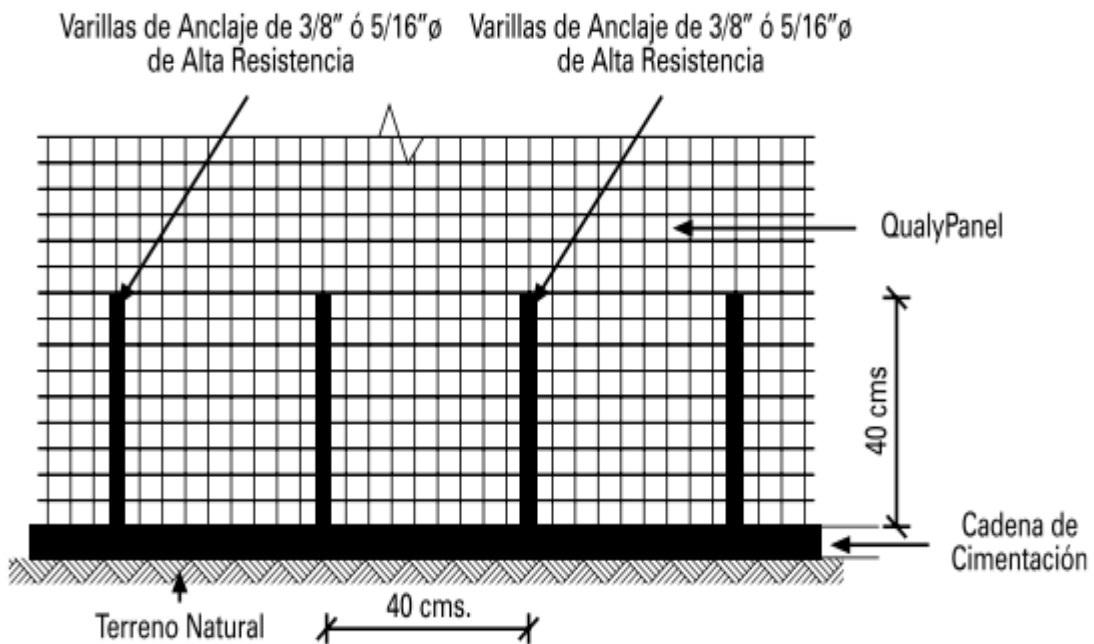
Unión del sistema Covintec a la cimentación (Alzado).
